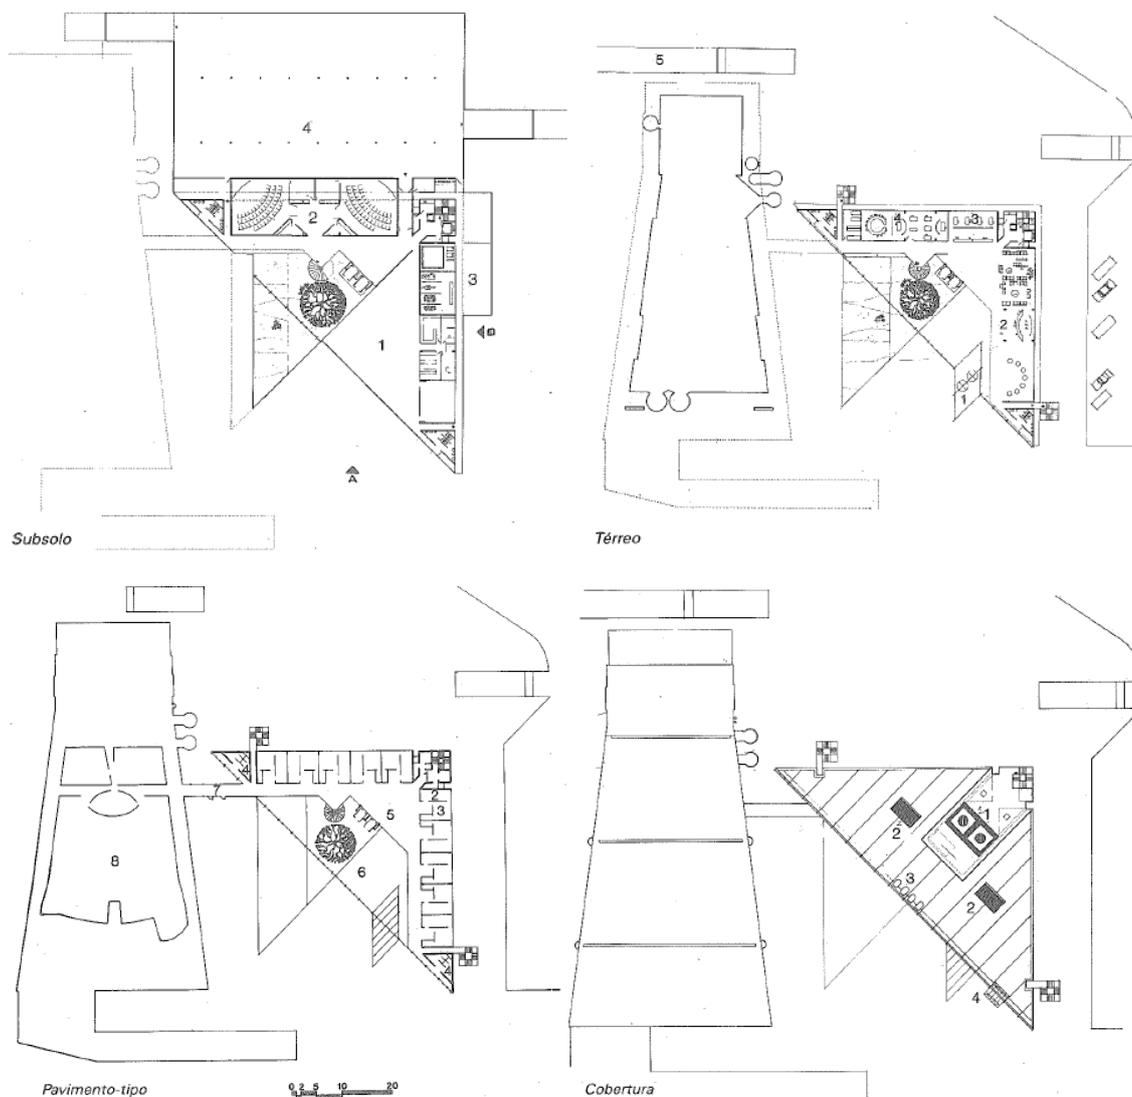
Plantas do Anexo Legislativo: subsolo, térreo, pavimento tipo e cobertura.
